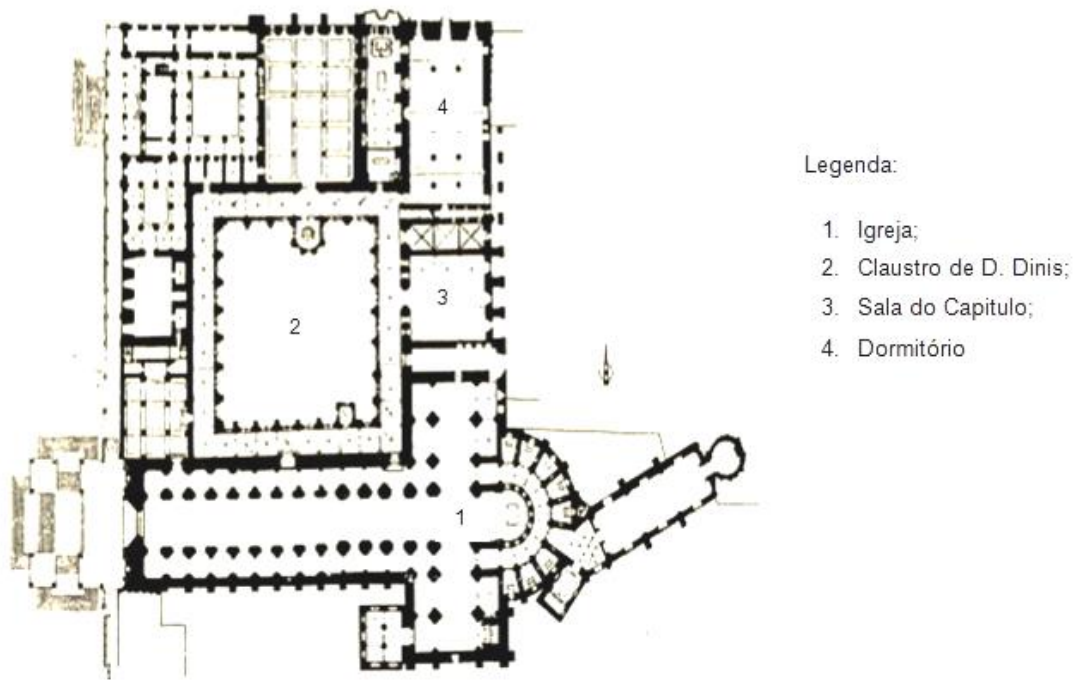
Planta da Igreja e do Claustro de Dinis em Alcobaça
